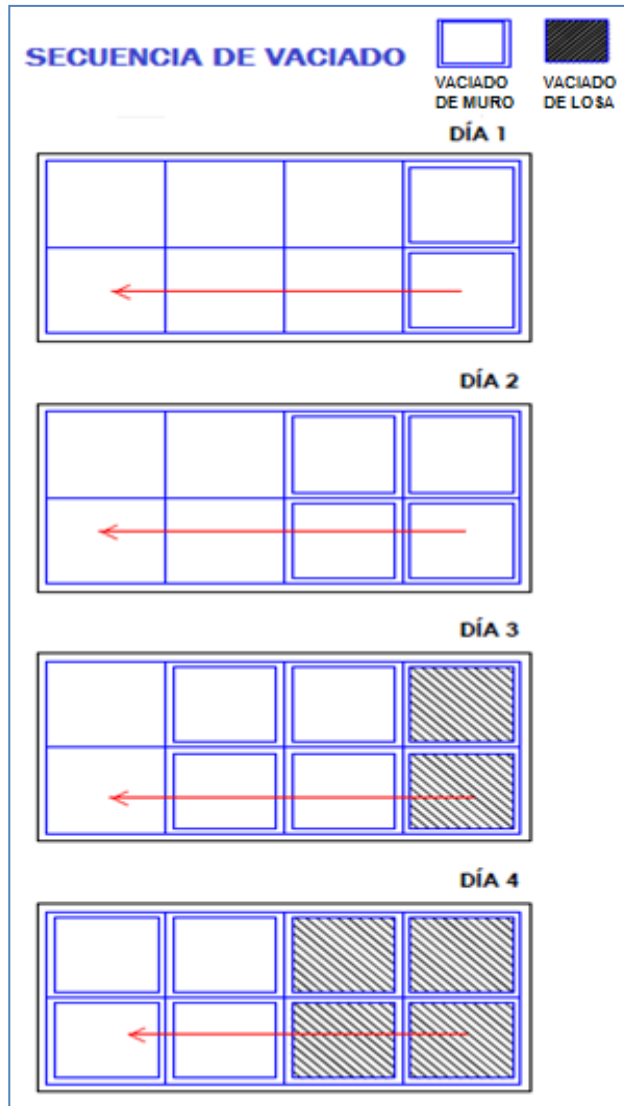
Vista en planta. Secuencia de vaciado de una planta.
